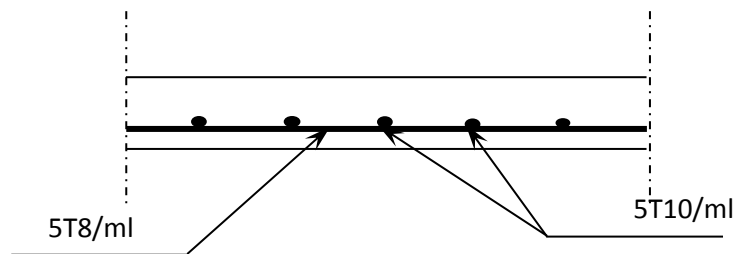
Schéma de ferrailage de la dalle pleine sur trois appuis.
